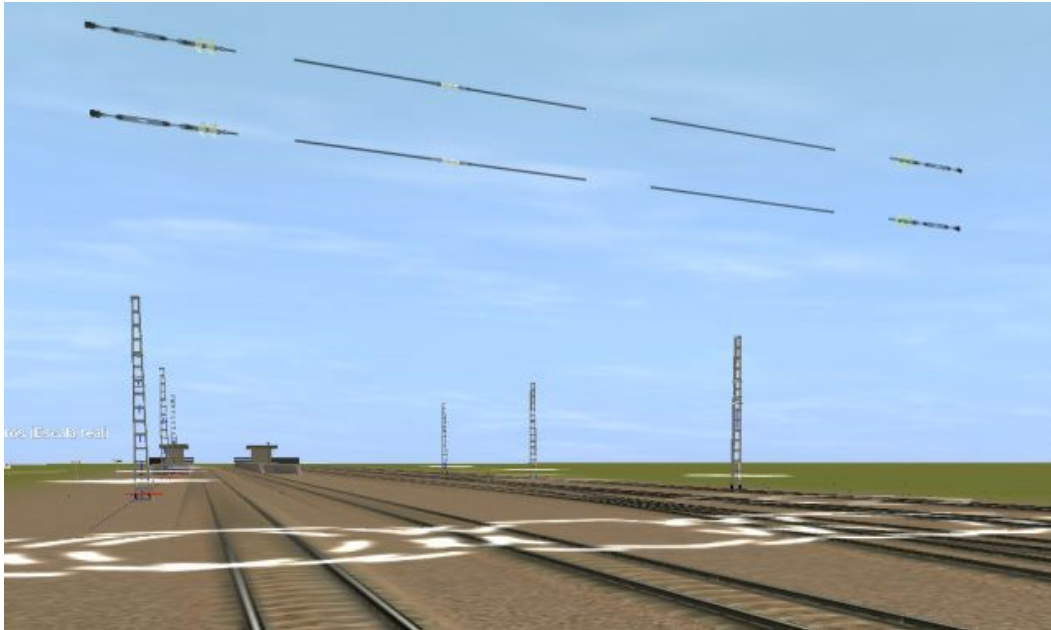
Elementos constituyentes de la transversal en pórticos funiculares.
